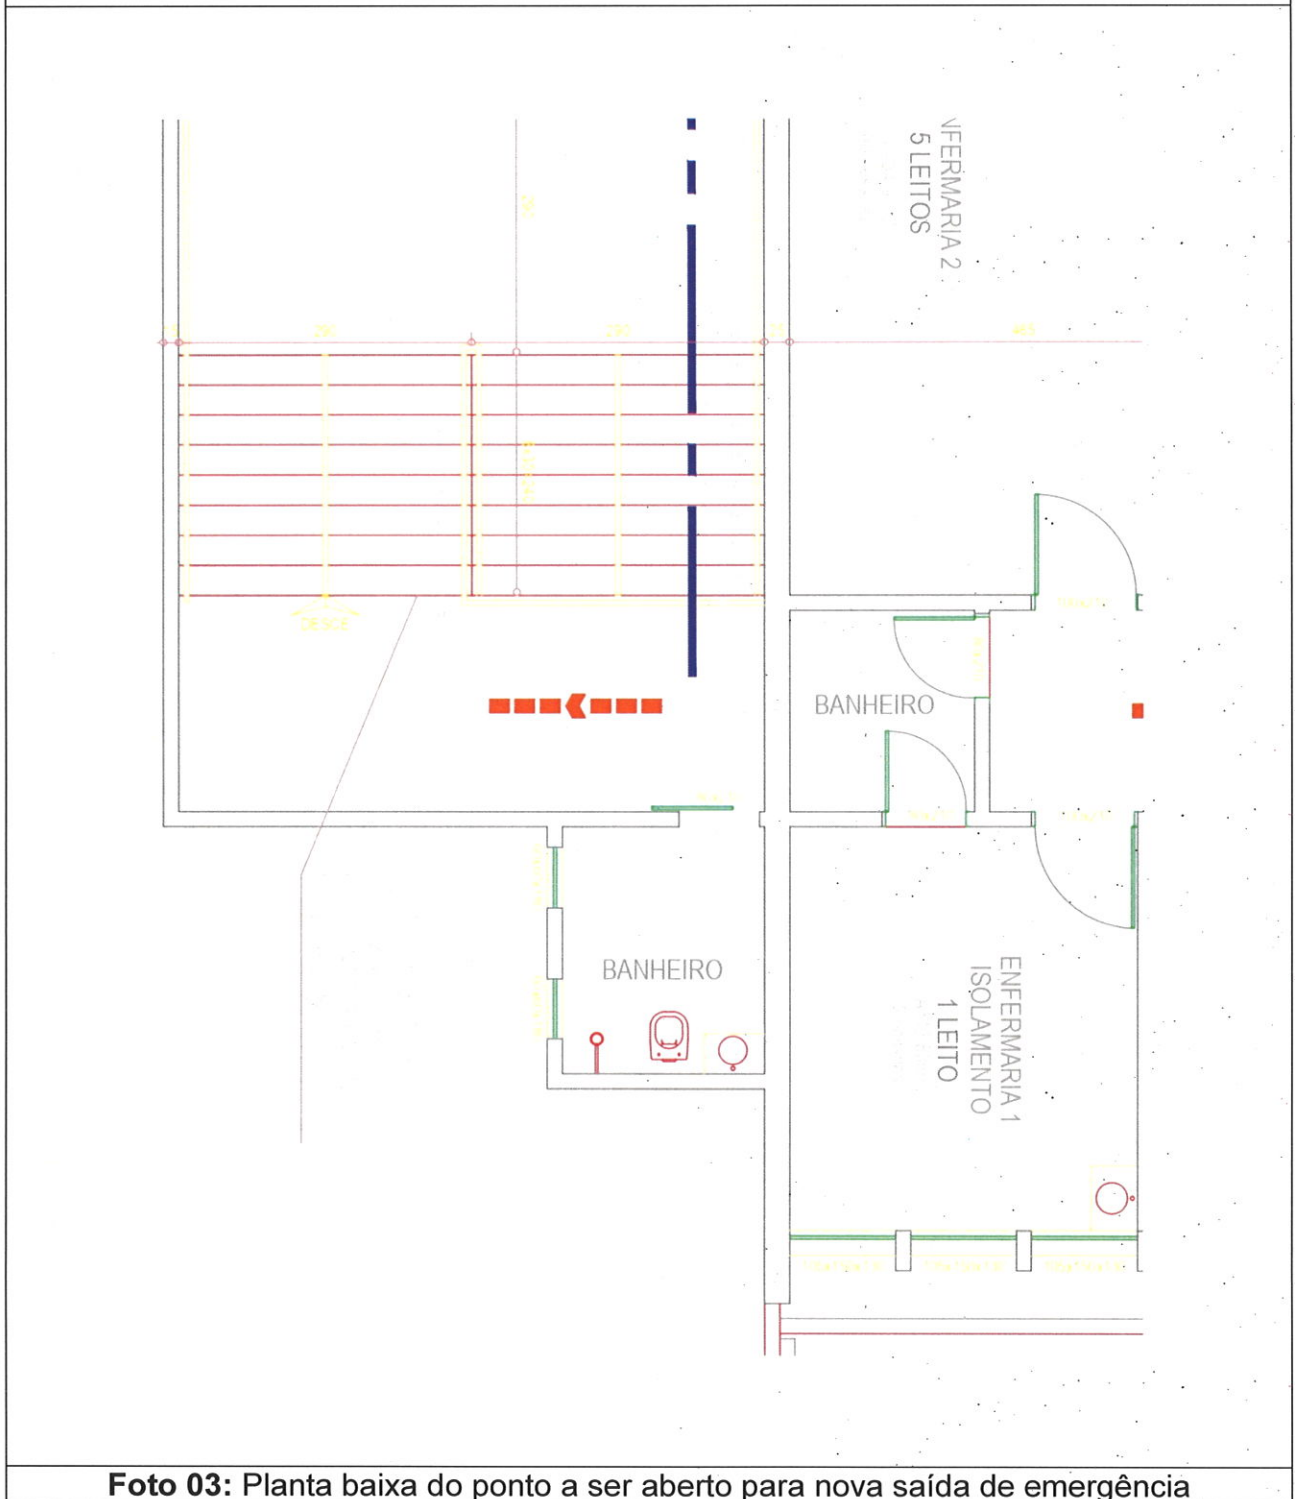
Planta baixa do ponto a ser aberto para nova saída de emergência
